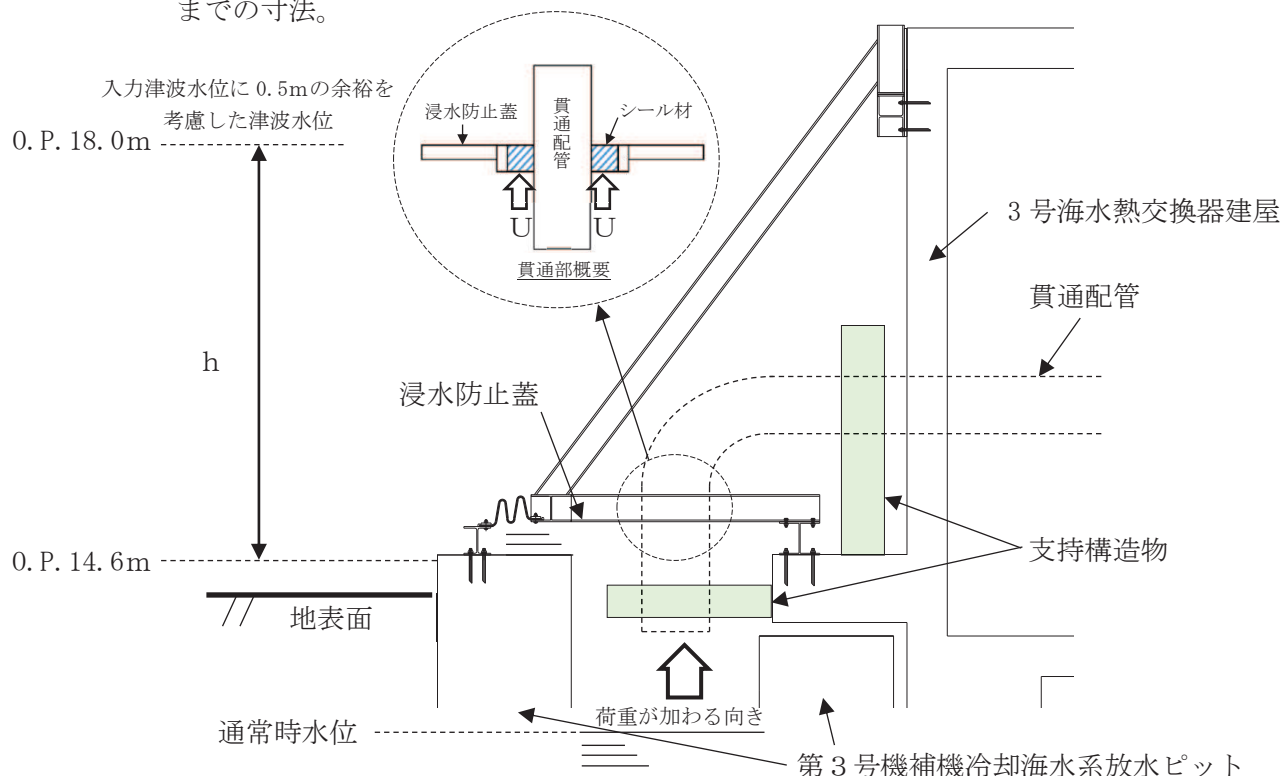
貫通部止水処置（貫通軸：鉛直）に加わる津波の概要
